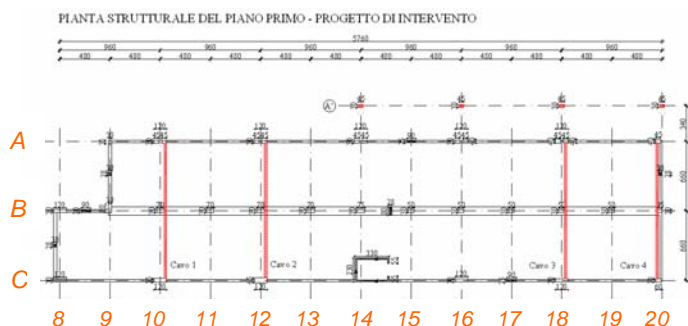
Pianta strutturale del primo piano della porzione del Padiglione Chirurgia oggetto dell'ipotesi di adeguamento, arreca la collocazione prevista per il sistema a cavi smorzanti
